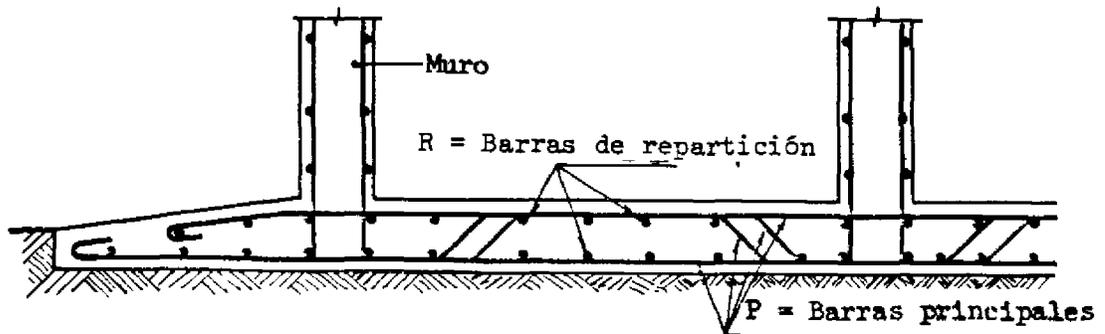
ARMADURAS DE LOSAS DE FUNDACION
